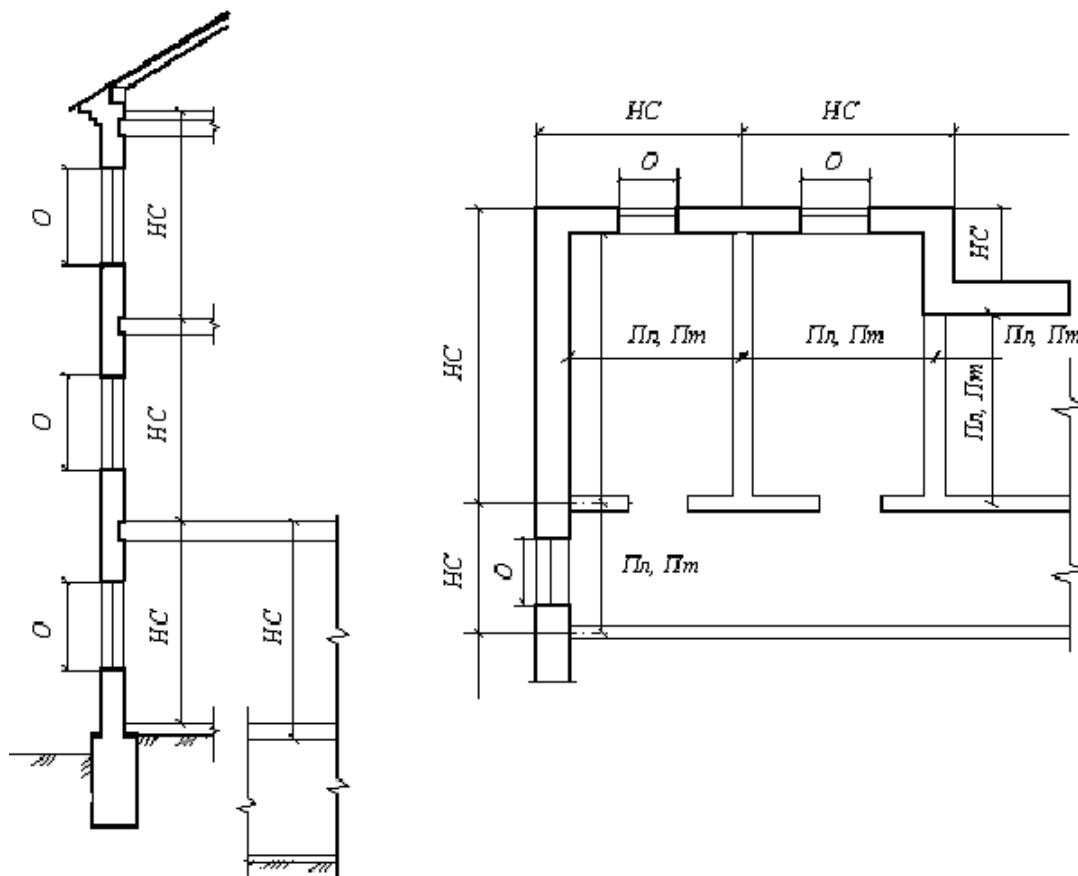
Правила обмера площадей в плане и по высоте здания
